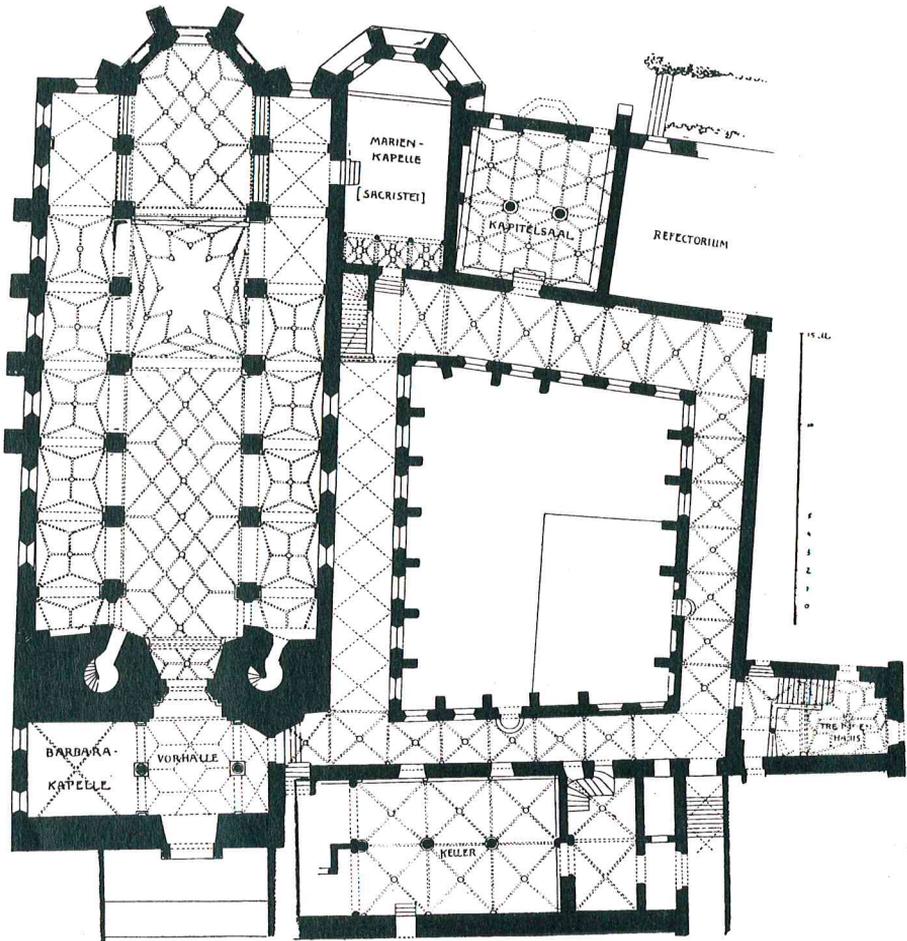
Seon, Lkr.Traunstein. Gesamtgrundriss mit achteckigen Türmen und Wendeltreppen (nach Kunstdenkmale des Königreiches Bayern 2 [Anm. 39] 1832).
